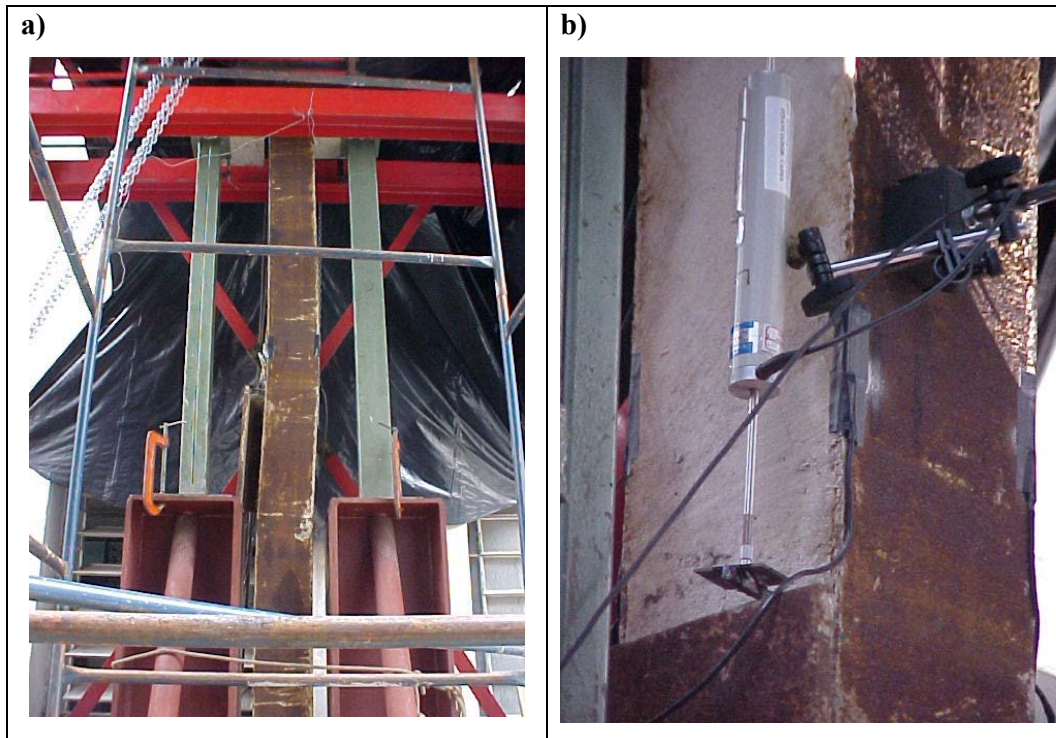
Modelo MAA, a) Após ensaio; b) Instrumentação logo acima do apoio.
